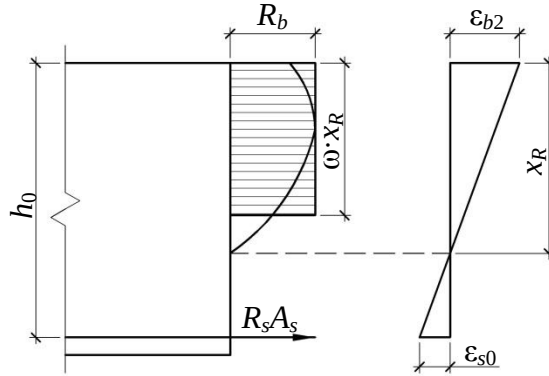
Схема определения граничной относительной высоты сжатой зоны бетона в изгибаемом железобетонном элементе
